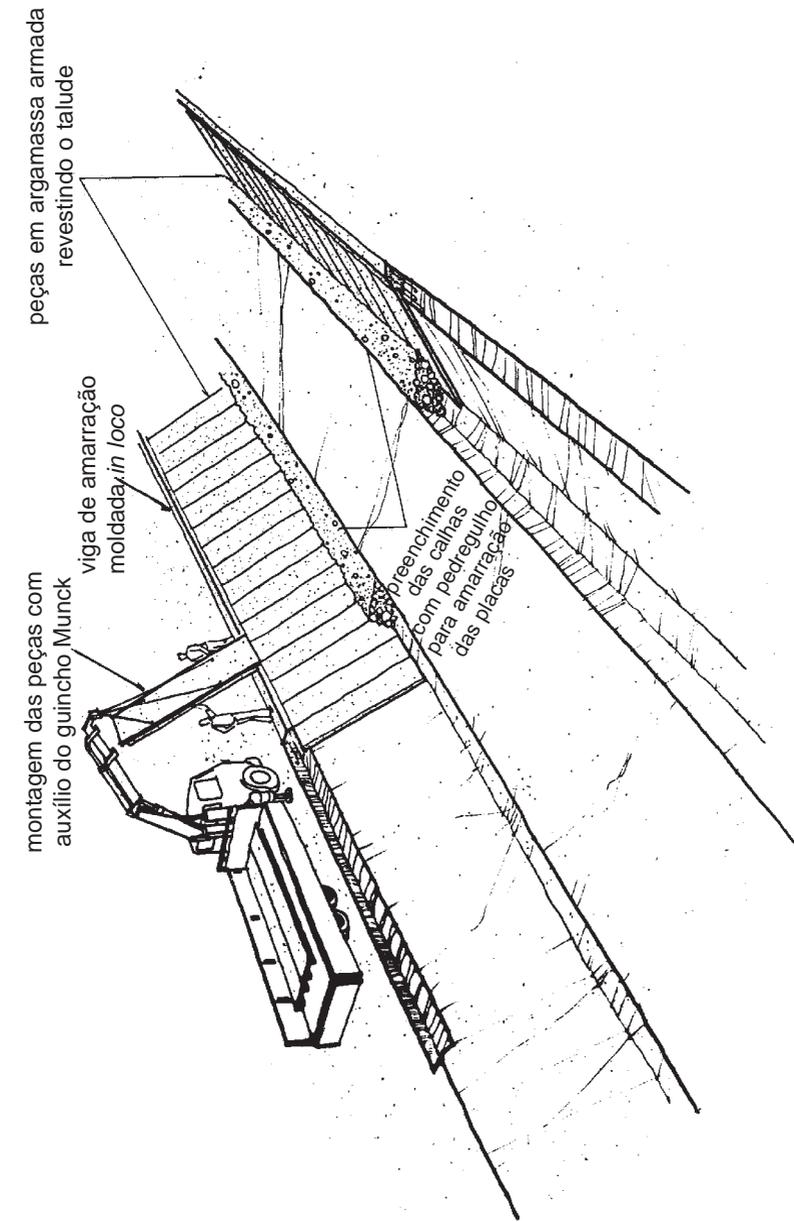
Operação de revestimento dos taludes - Vista esquemática
